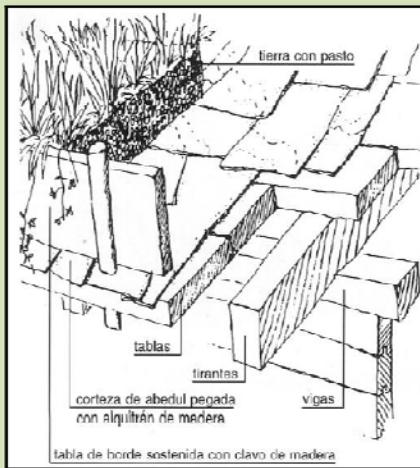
Esquema de una cubierta verde tradicional en Escandinavia.
